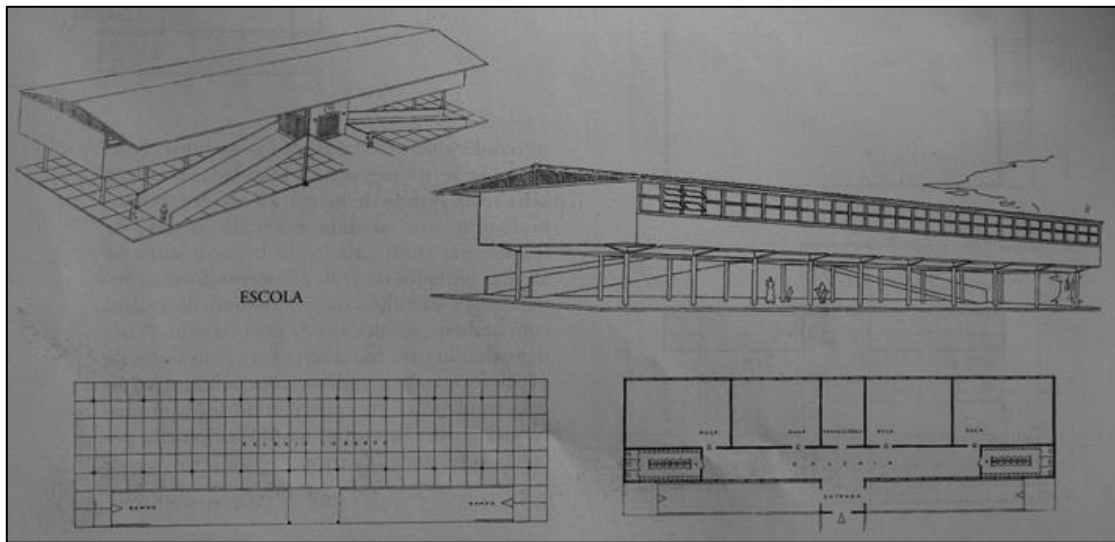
Vila Monlevade. Planta dos pavimentos térreo e superior da escola. Perspectiva da escola. 1934. Arquiteto: Lucio Costa. Fonte: COSTA, 1995.
